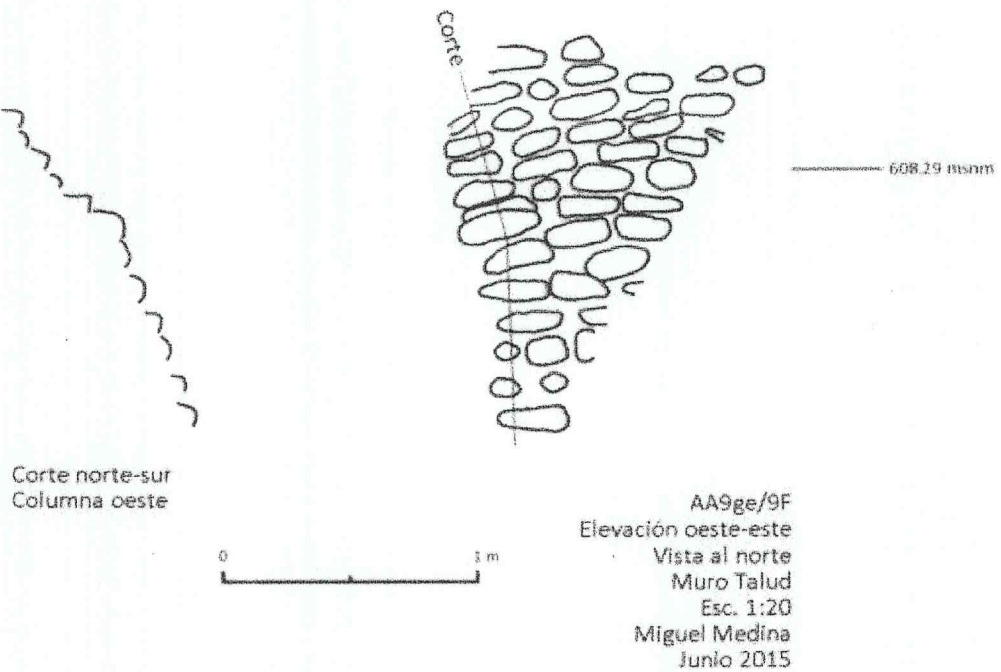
Op. AA9ge, corte norte-sur y elevación oeste-este del muro talud.
